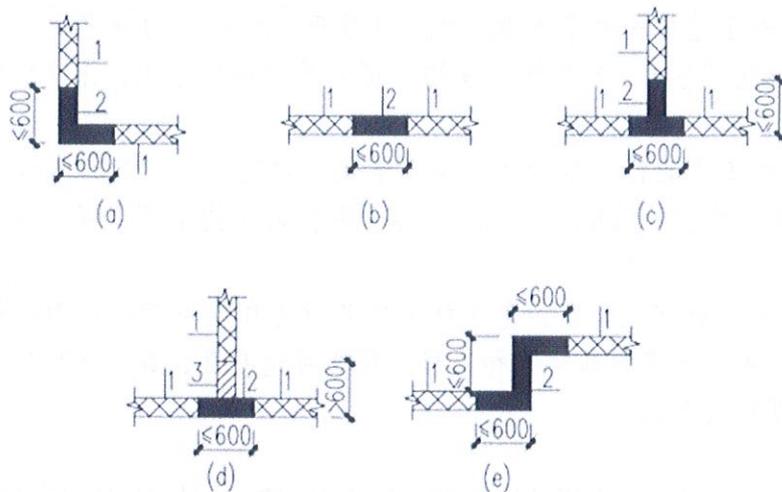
预制剪力墙板间可计入预制混凝土体积的现浇段示意图
